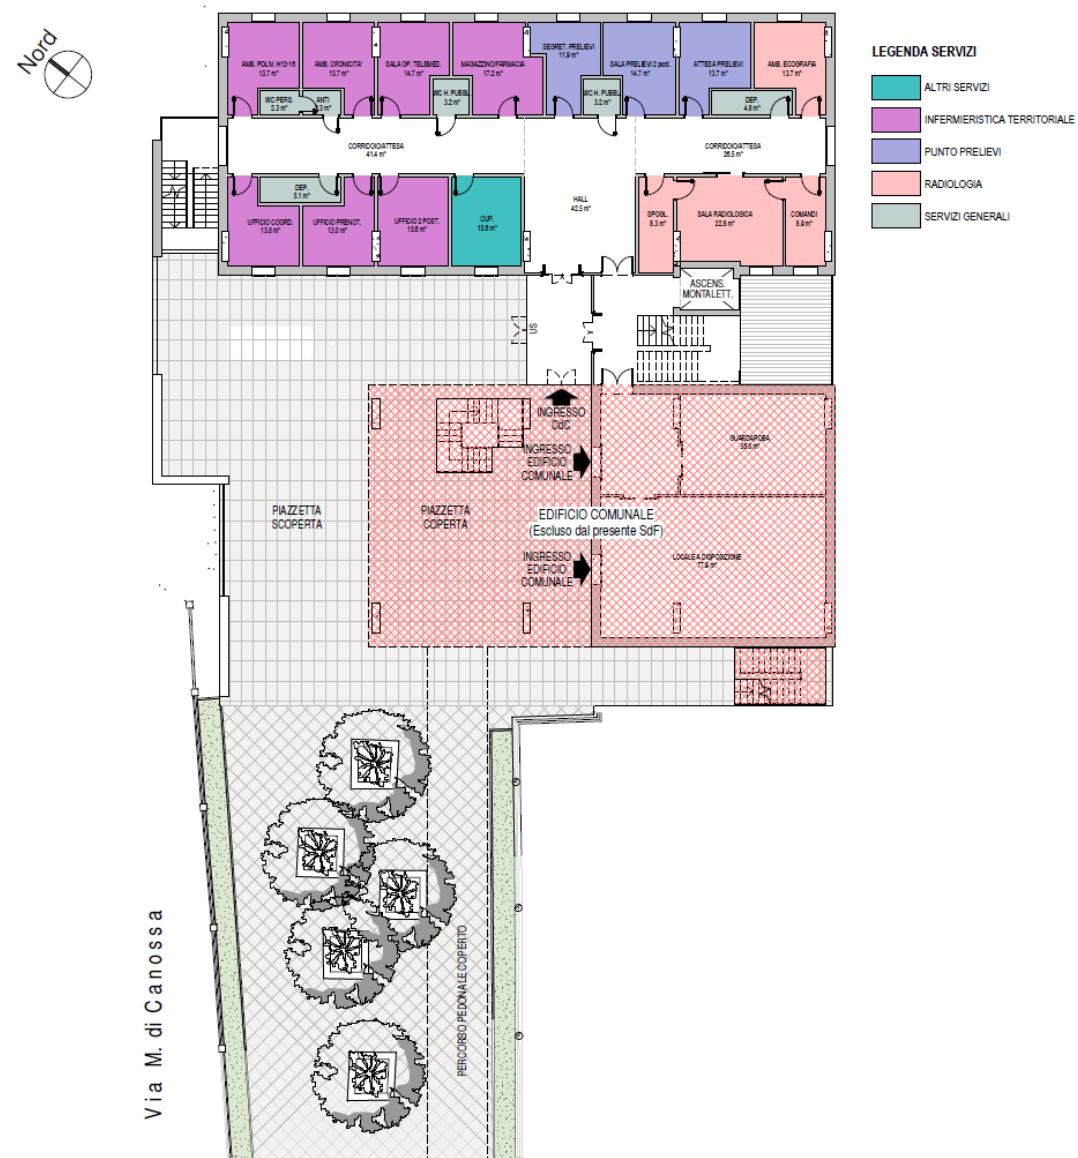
Pianta Piano Terra - Ipotesi di progetto
